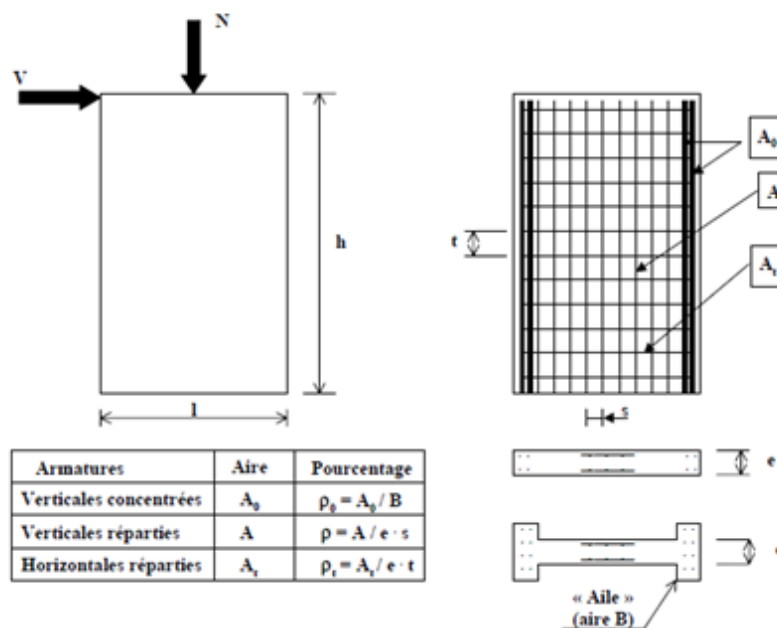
Schéma d'un voile plein et disposition du ferrailage
